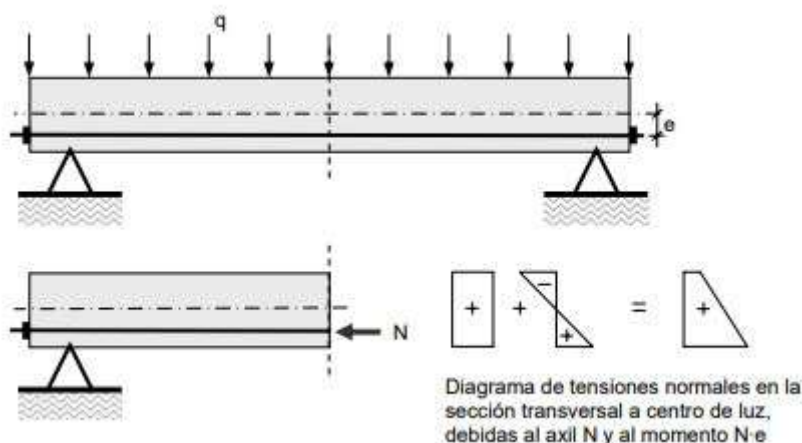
Aplicación de un estado previo de tensiones a una viga de hormigón mediante cabos de acero estirados y anclados en los extremos.
